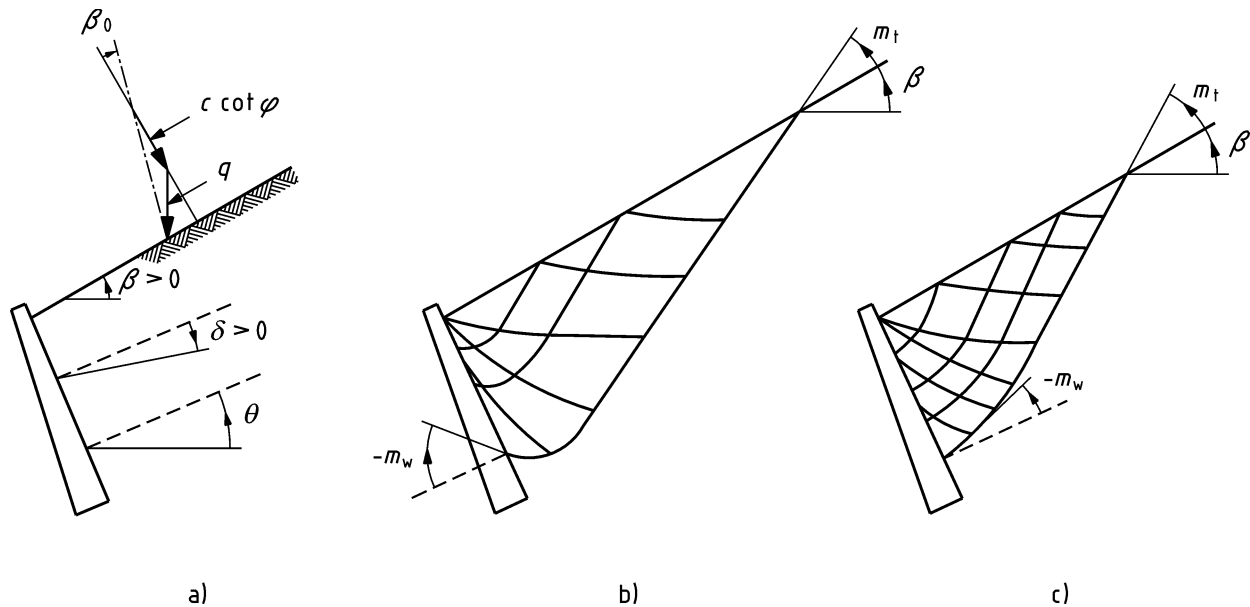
Bezeichnungen hinsichtlich Wand- und Hinterfüllungsneigungen, Auflasten und Gleitlinien
